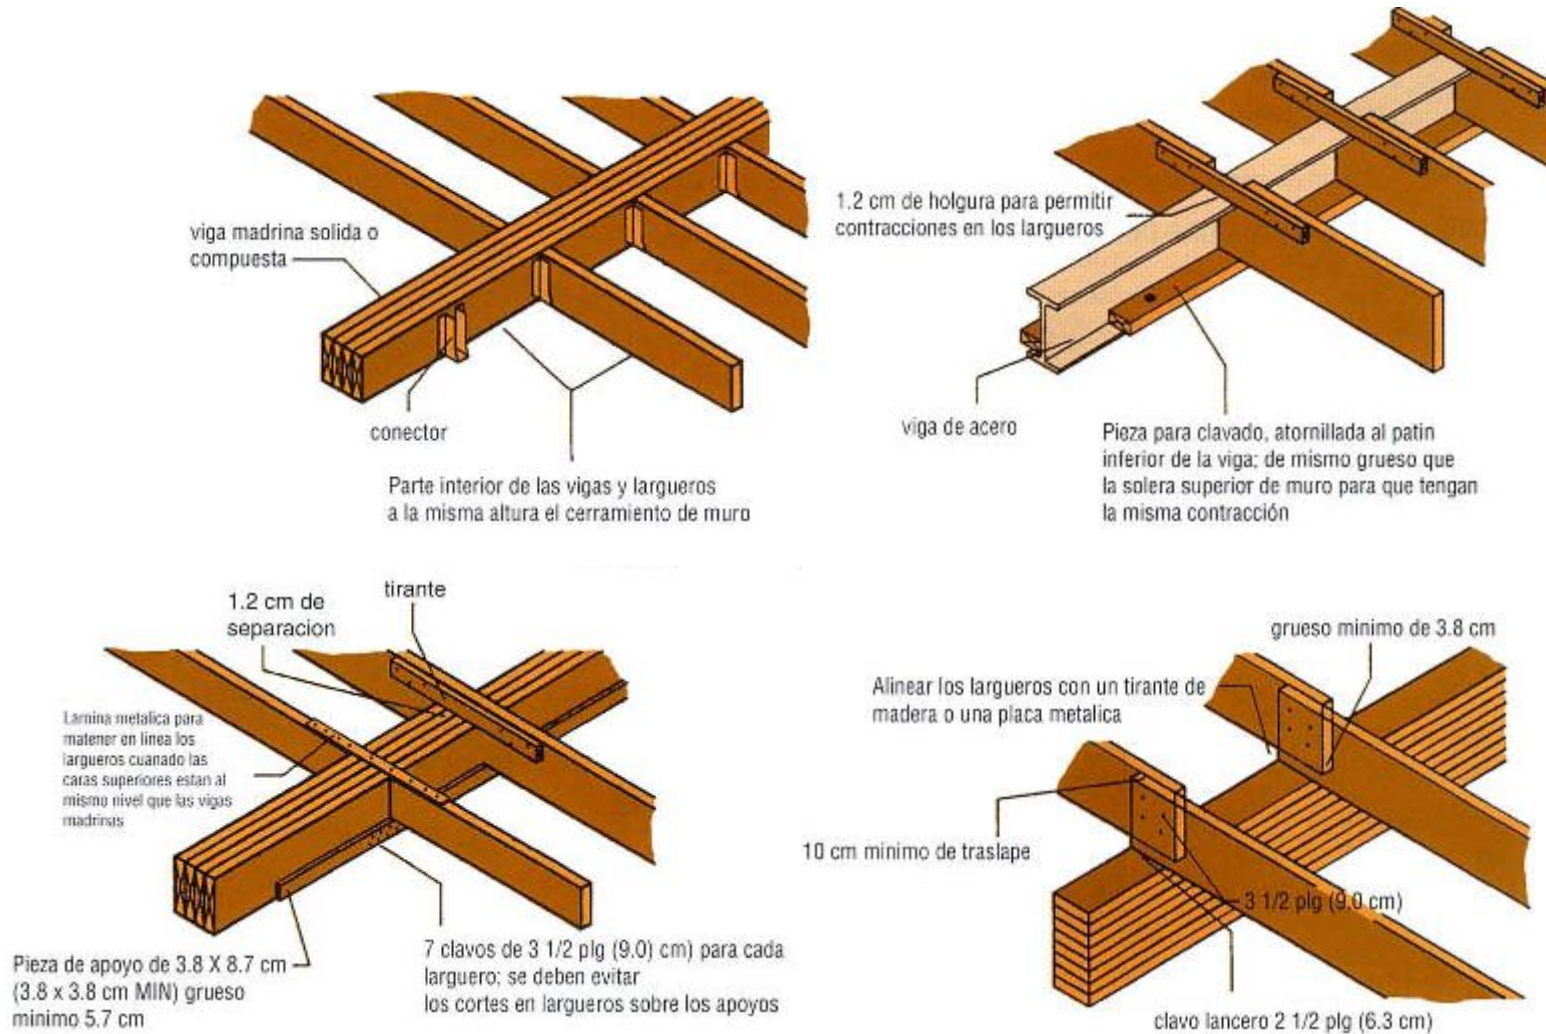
Apoyo de Viguetas en diferentes Tipos de Vigas Madrinas
